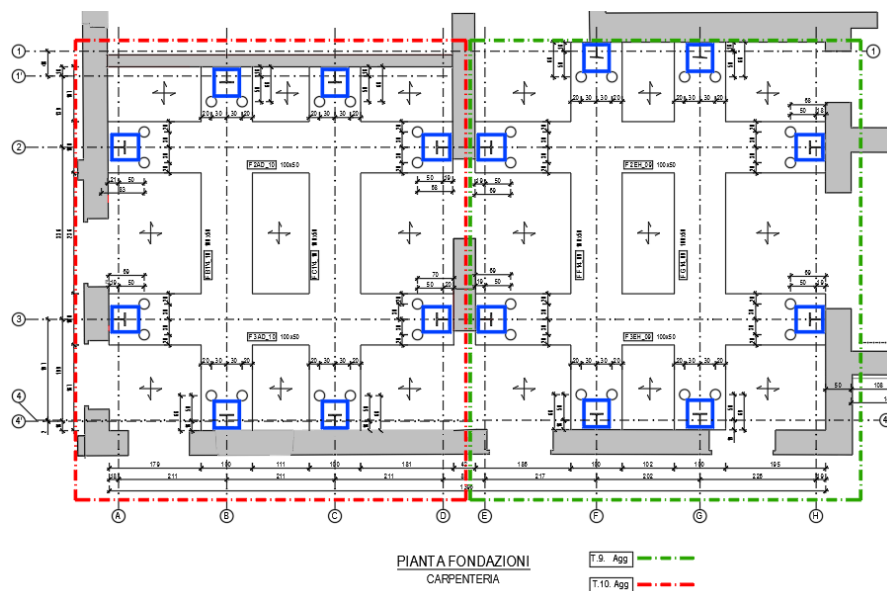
pianta fondazioni corpi T09_Agg. e T10_Agg. - in blu i giunti di base delle strutture metalliche
